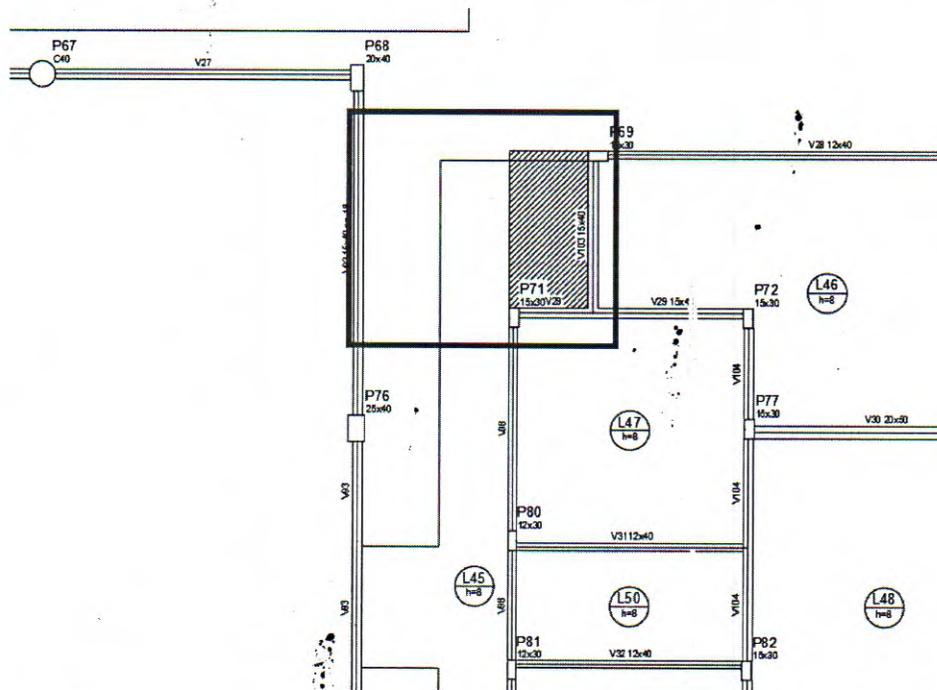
Prolongamento (hachurado) feito entre as lajes L46 e L47. Fonte: Acervo técnico
